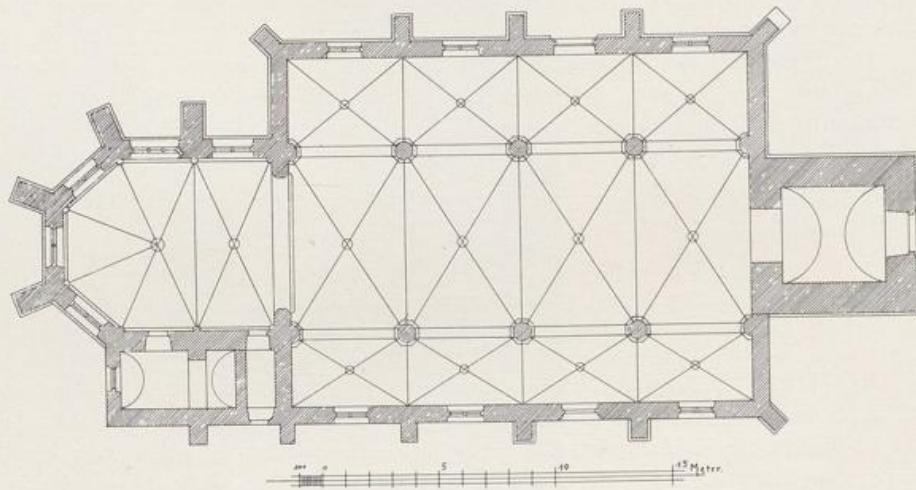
Langerwehe. Grundriss der alten kathol. Pfarrkirche.
